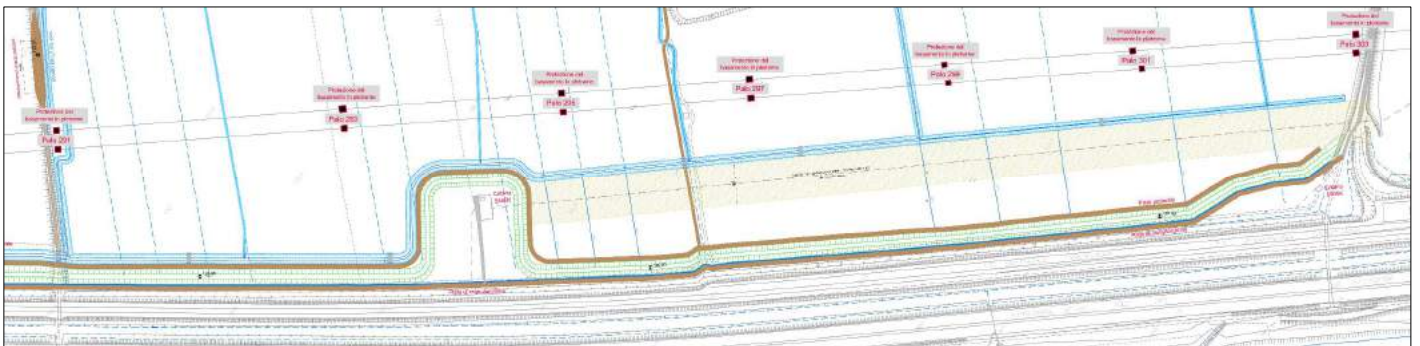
estratto da Tav. RT.06.03 del progetto esecutivo Pizziconi 2009 con evidenziato la posizione della line a A.T.
